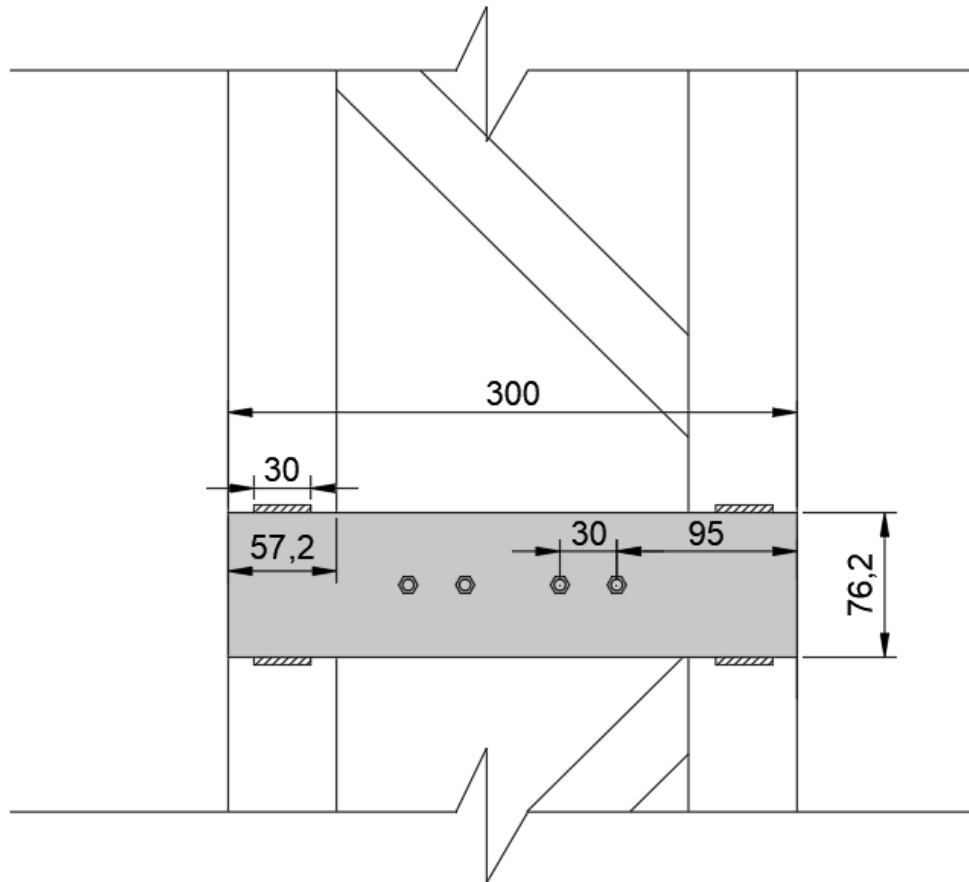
Detalle unión correa de techo - viga de pórtico (Planchuela) – Vista superior
